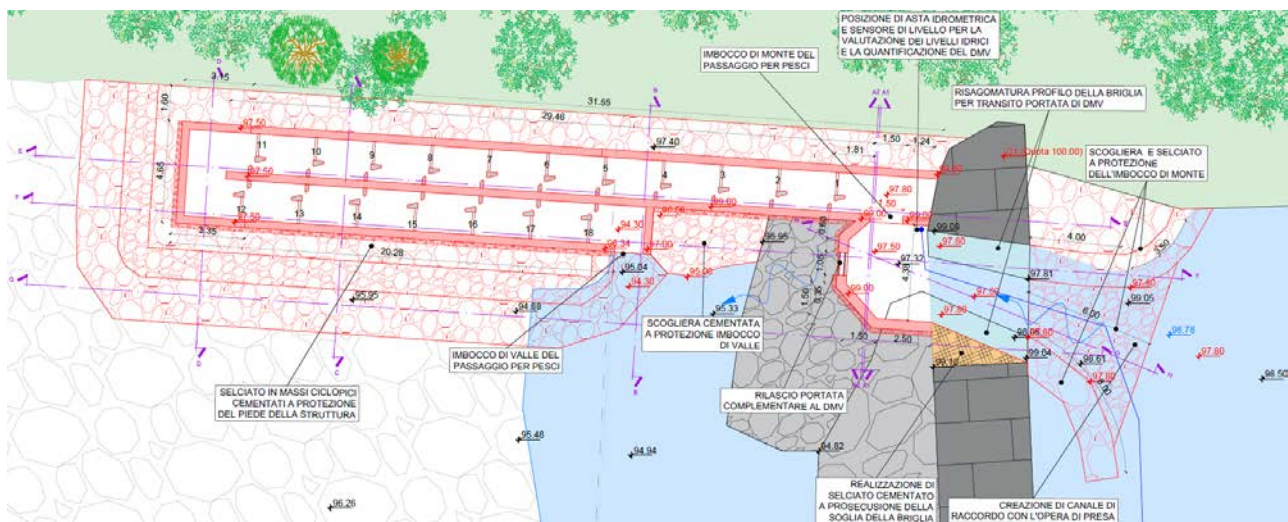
planimetria del passaggio per pesci in progetto estratto tavola C.2.3
